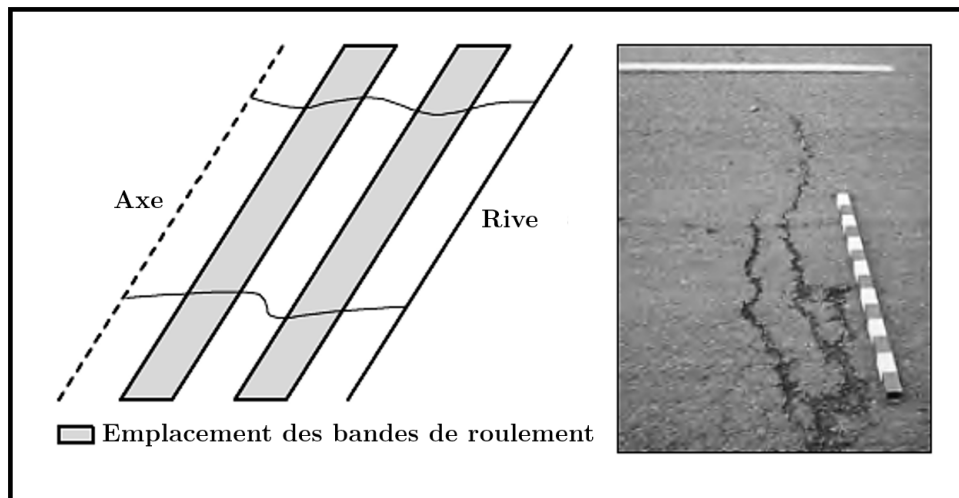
Schéma d'une fissuration transversale [Di Benedetto and Corté 2005]
